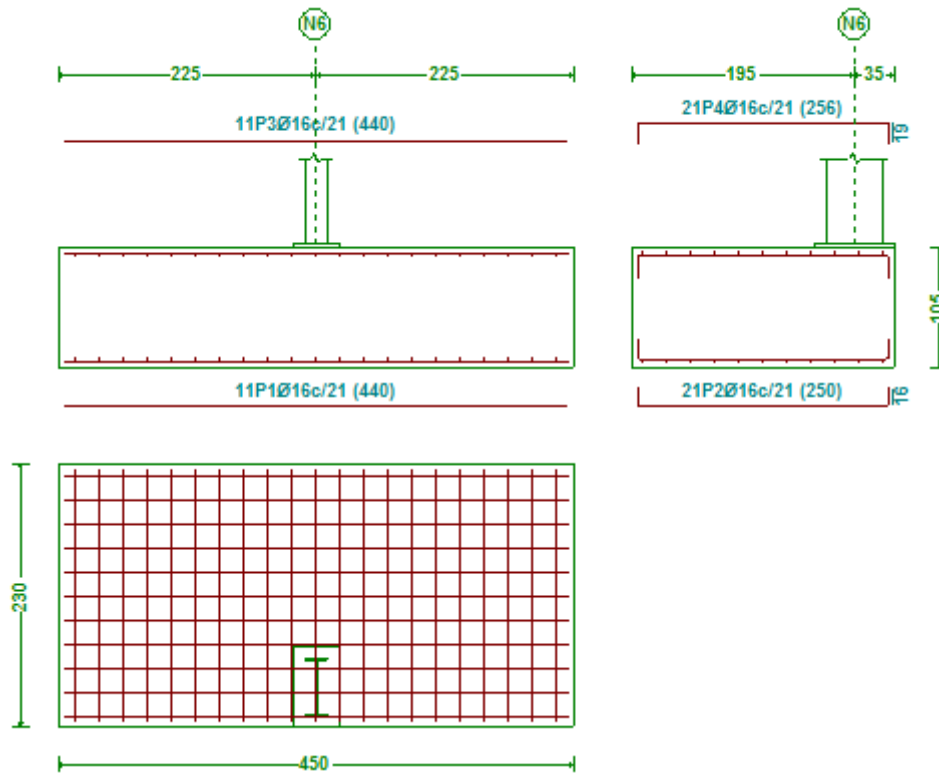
Zapatas pilar izquierdo de los pórticos interiores (Tipo 2)
